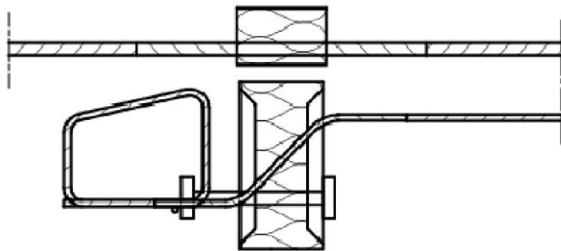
Schöck Isokorb® Typ KX-ID mit Stahldrucklager
